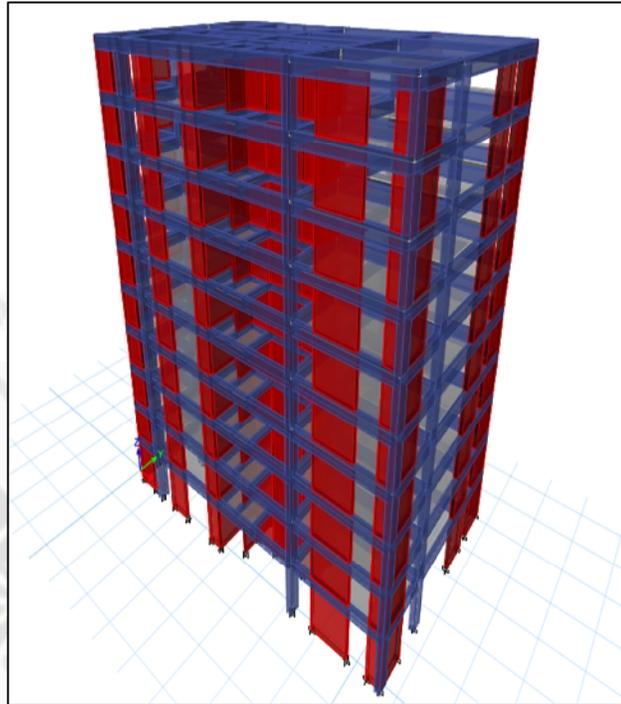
Estructuración Edificio Multifamiliar I – ETABS 2015.
